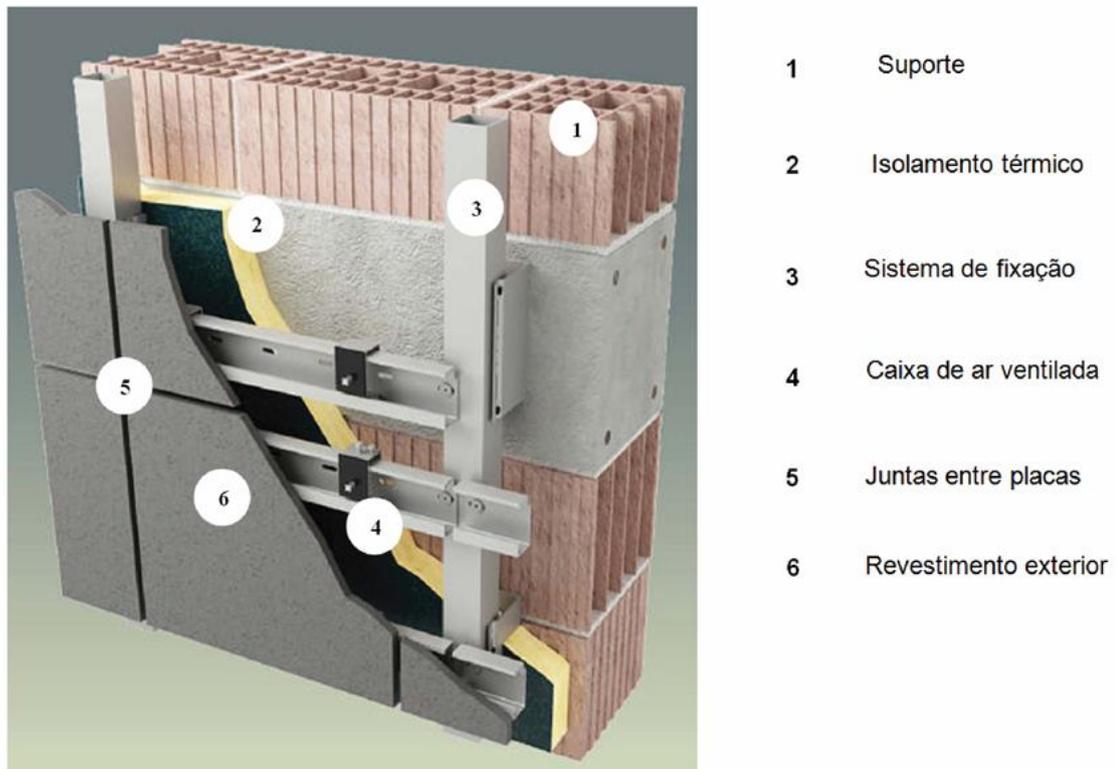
Revestimento de fachada ventilada, com placas metálicas.
